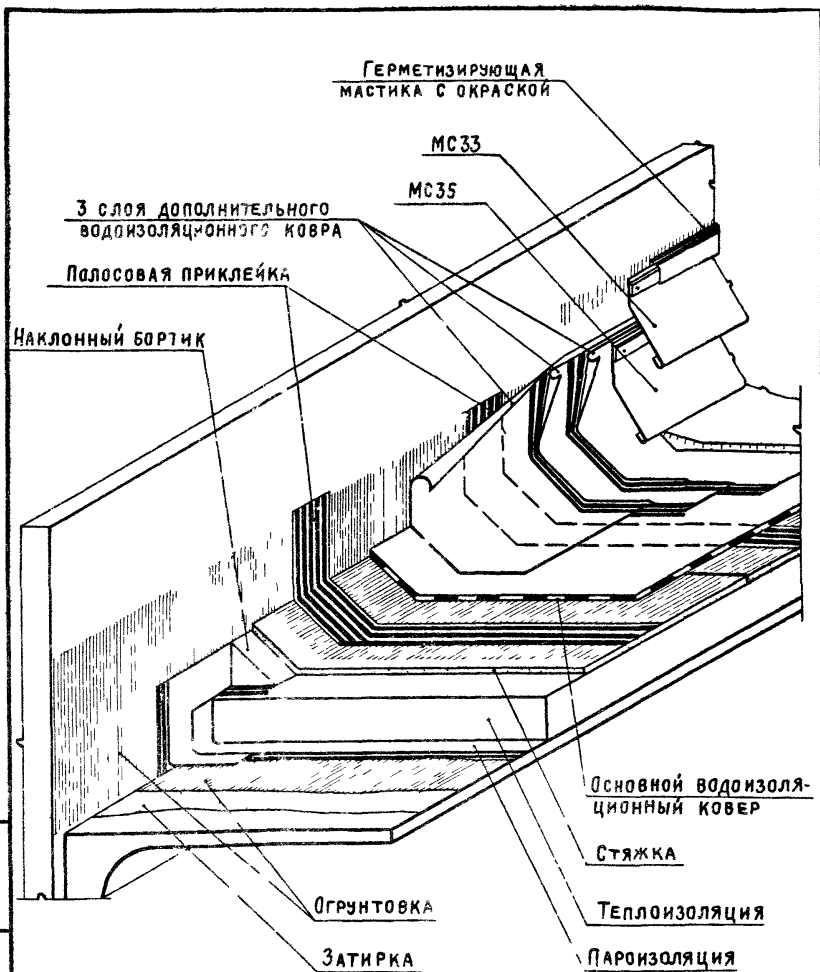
Парапет продольной стены высотой более 450 (с выходом водяных паров) с уклоном кровли до 2,5%
